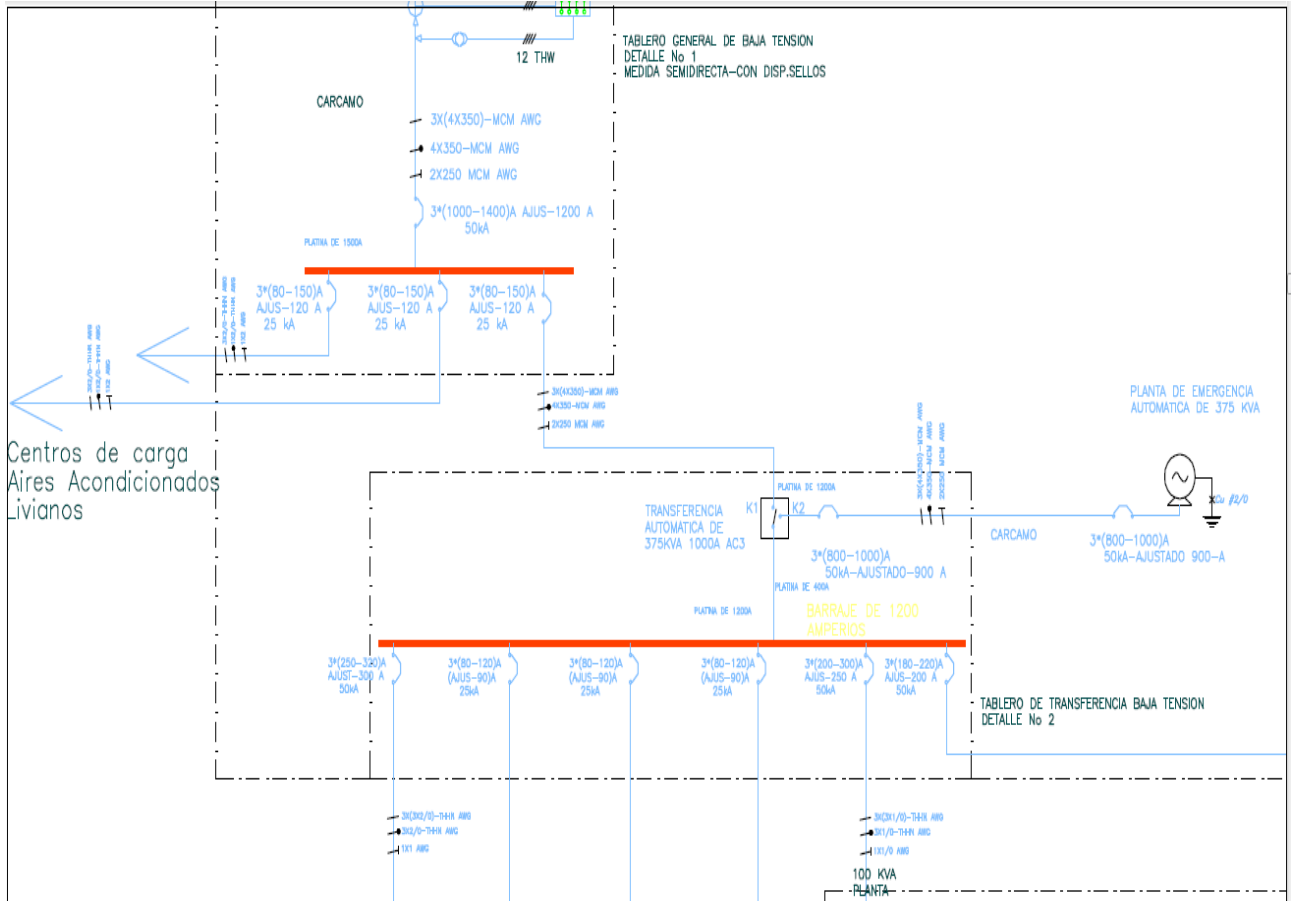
Tablero general de baja tensión y tablero de transferencia de baja tensión conectado a planta de emergencia
